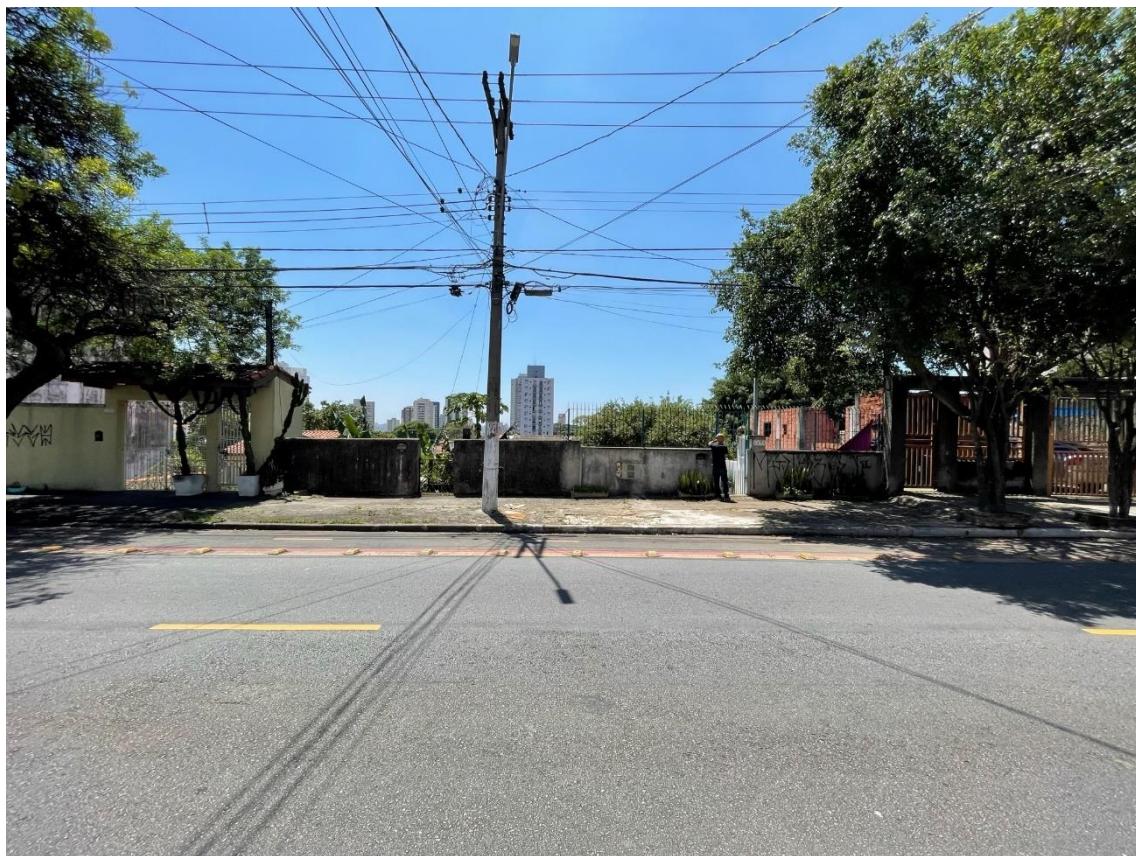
Vista da testada do imóvel pela rua Dr. Mário Vicente e ciclofaixa rente limite ao calçamento.
